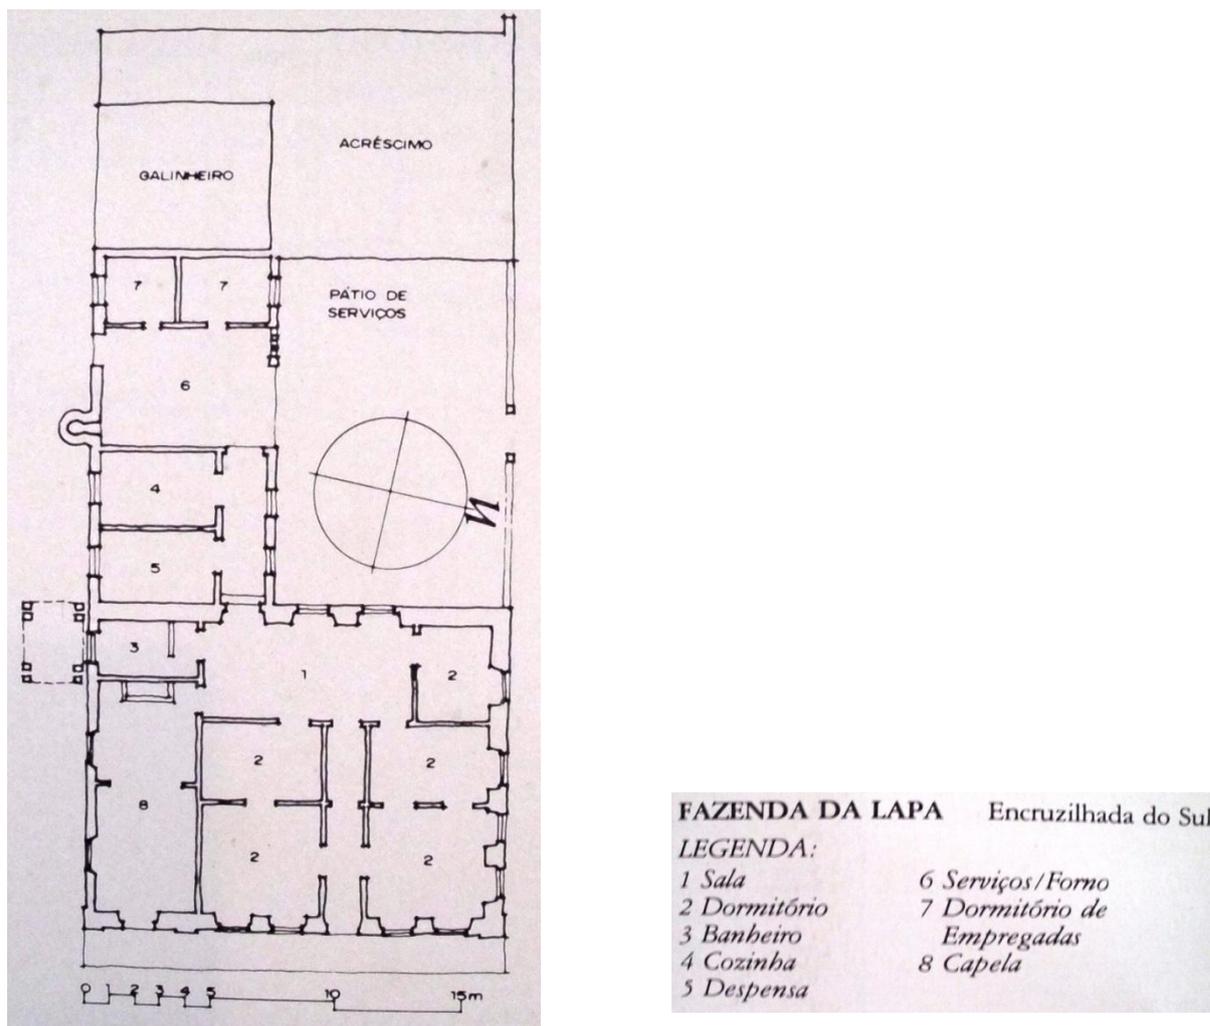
Planta baixa esquemática da edificação na Estância da Lapa em Encruzilhada do Sul
